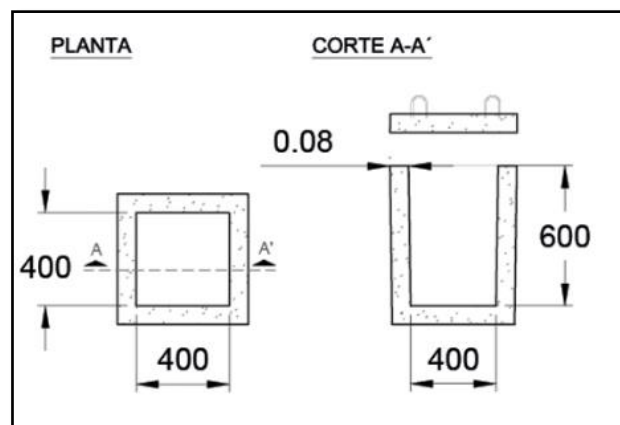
Premoldeados Argentina, 2021, Dimensiones de cámara de inspección de PAT, imagen, [https://www.premoldeados.com.ar/portfolio/camara-tipo-b-60x60-h-60-sin-fondo-2-2-2-2-2/21](https://www.premoldeados.com.ar/portfolio/camara-tipo-b-60x60-h-60-sin-fondo-2-2-2-2/21)
